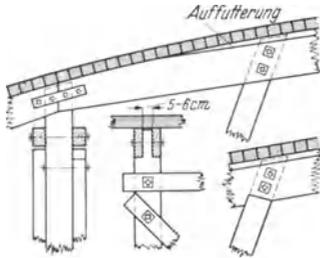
Verbindung der Pfosten und Streben mit zweiteiligen Kranzhölzern in einem Lehrgerüst (nach Mörsch, 10b).
